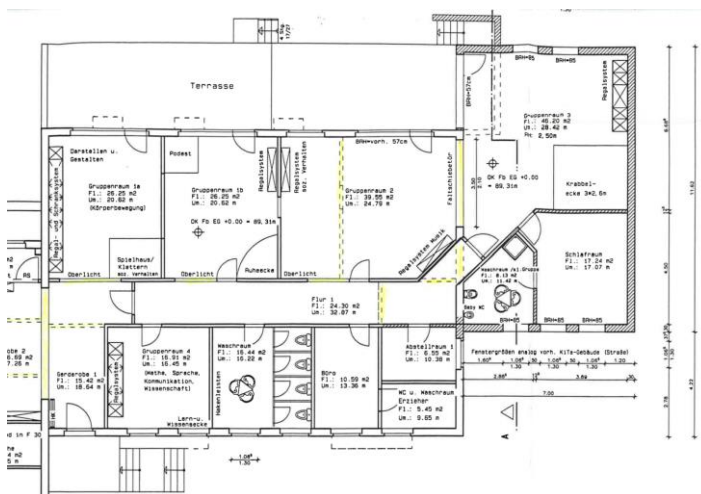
Ausschnitt Grundriss Erdgeschoss „Anbau Kita Prötzel“, Ingenieurbüro für Bauplanung, Jörg Stiller [7]
